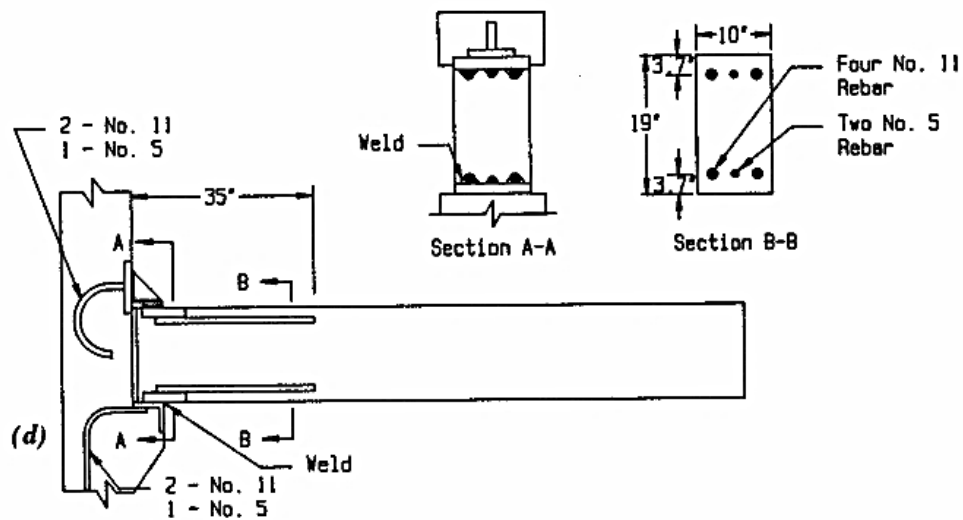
Sección transversal para la conexión de placa soldada
